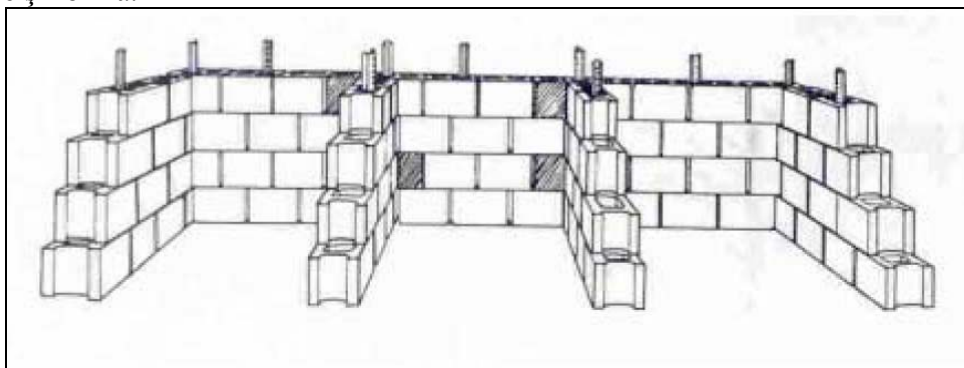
Adăpost din beton pentru depozitare și compostare (sursa PSSLC)
